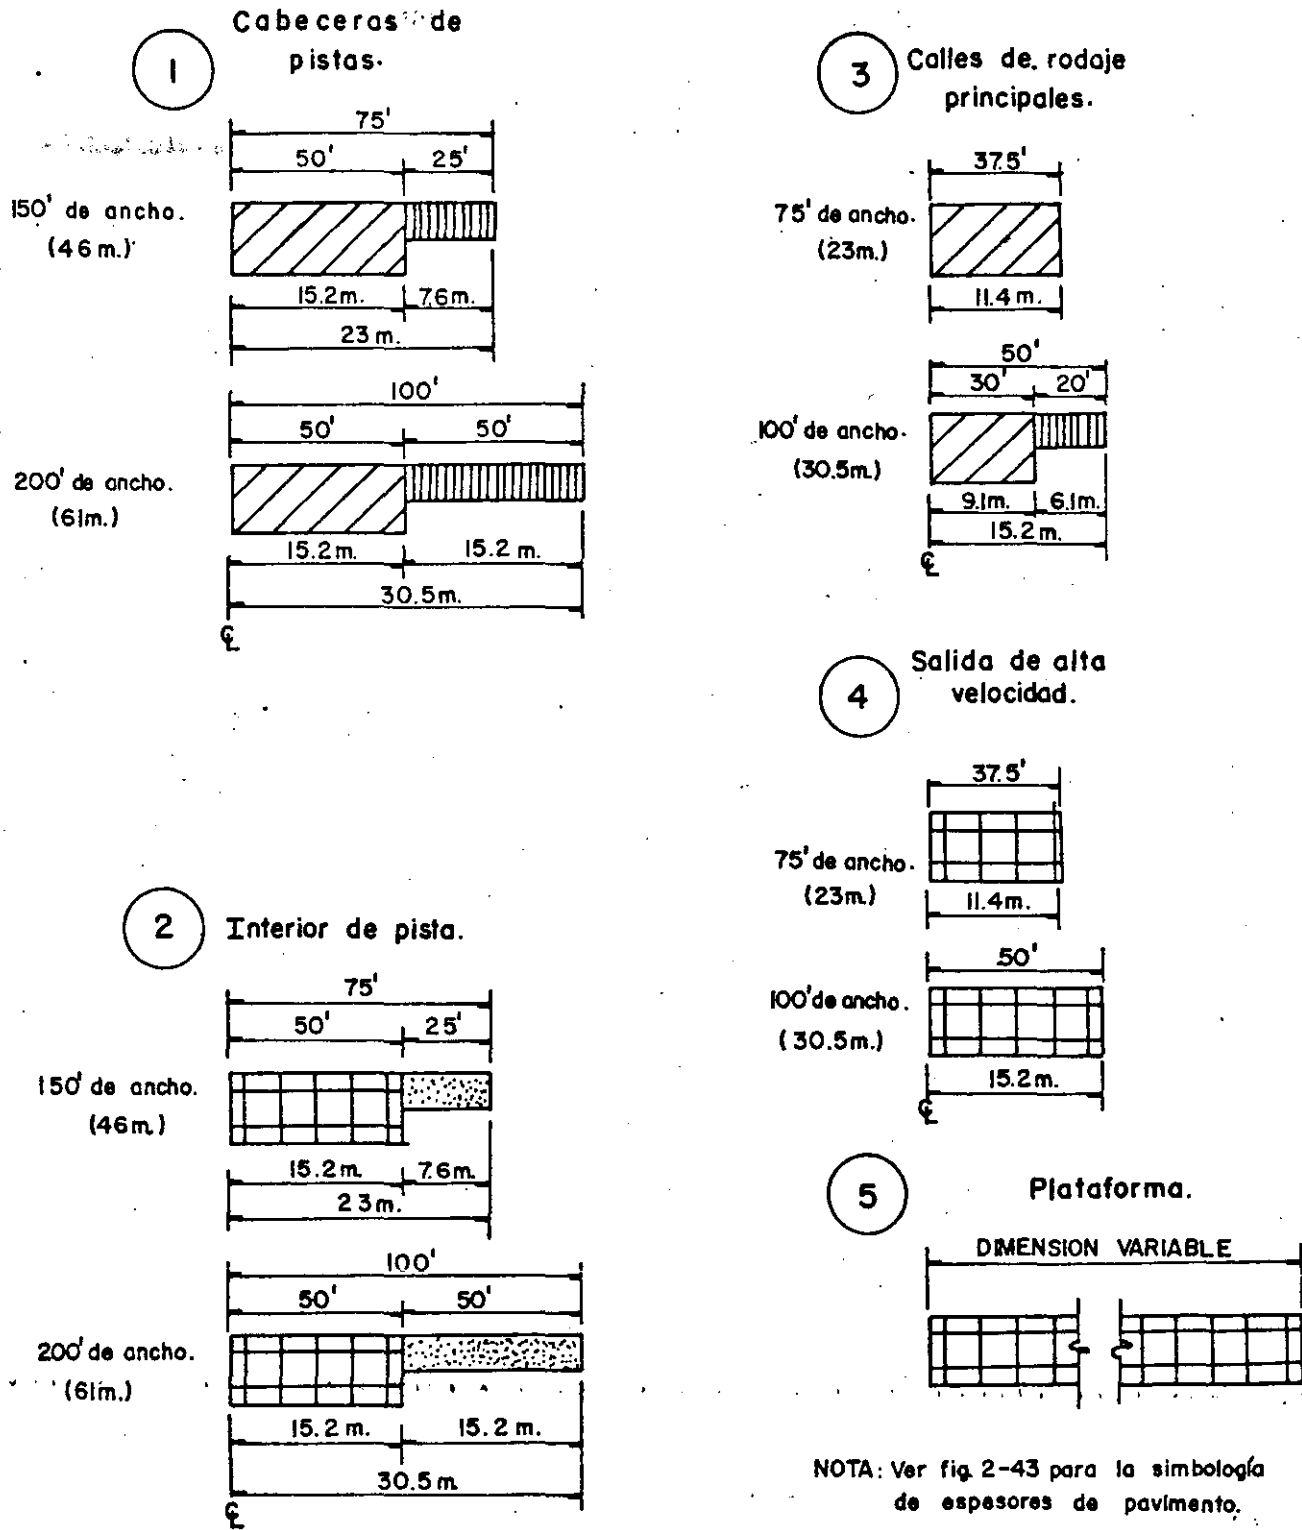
Secciones transversales de pavimento. (Instituto del asfalto 1973)
